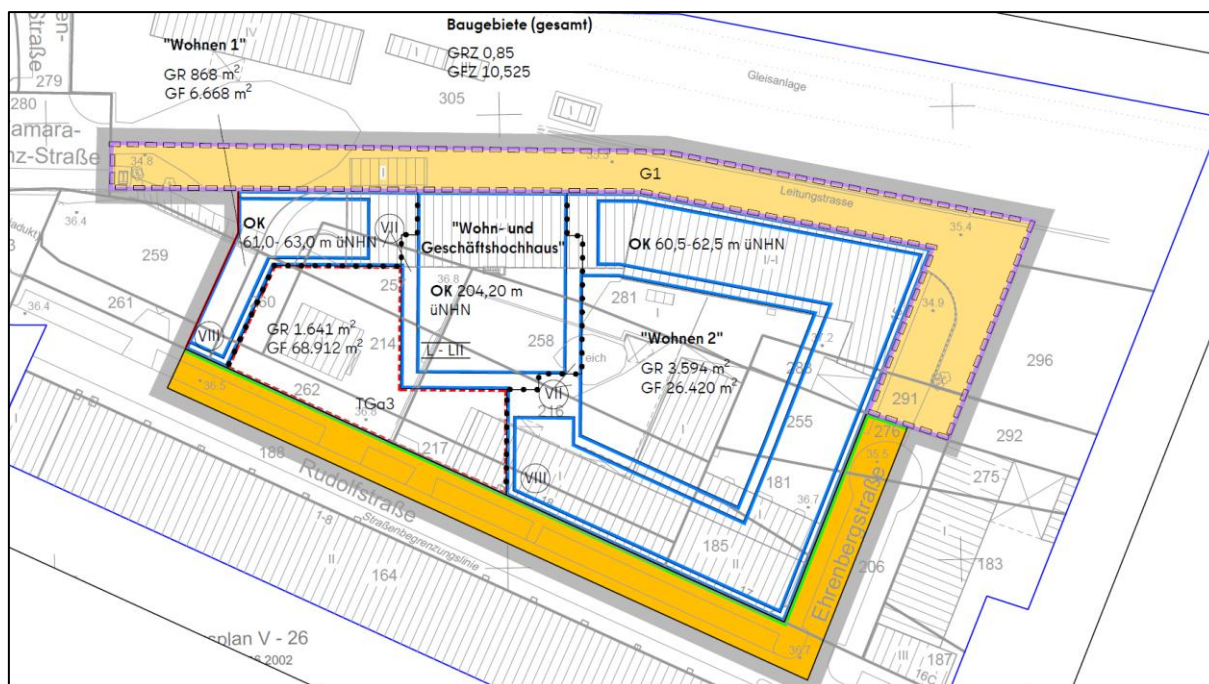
Erschließungsplan zum Bebauungsplan V-67a VE (Arbeitsstand 21.01.2026)
